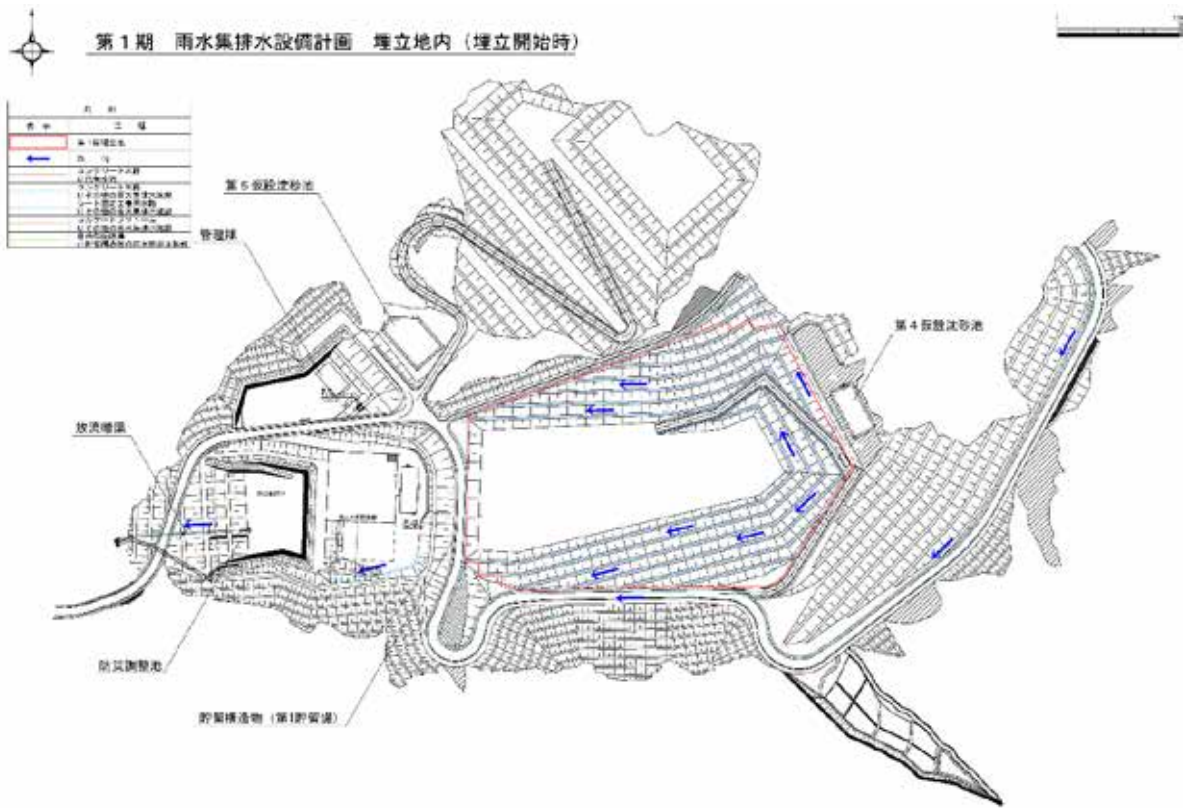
雨水集排水設備配置図 第1期埋立開始時
